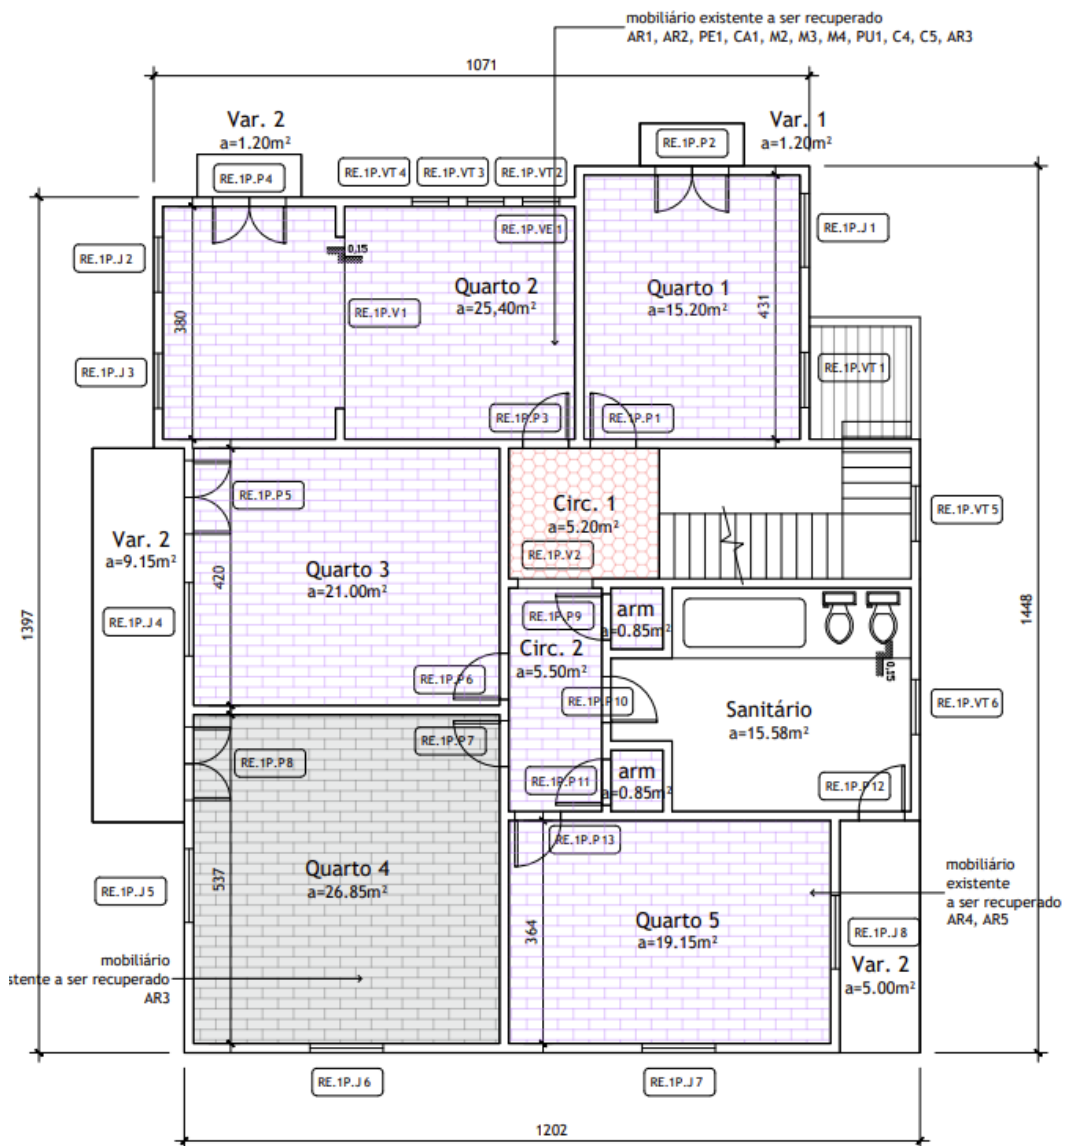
Planta baixa 1º pavimento [Fonte: Projeto Arkto – “Planta baixa térreo e 1º Pavimento”].
